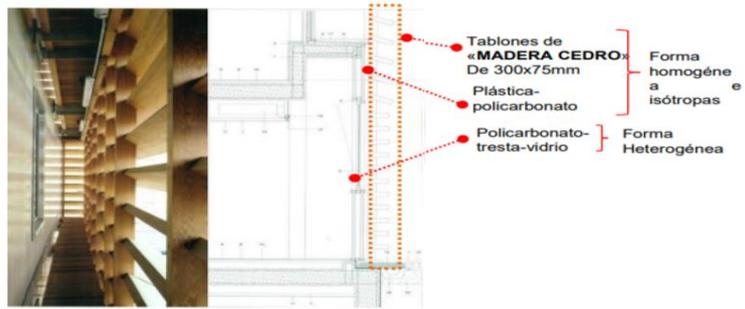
Detalle arquitectónico ubicación de cobertura de madera
